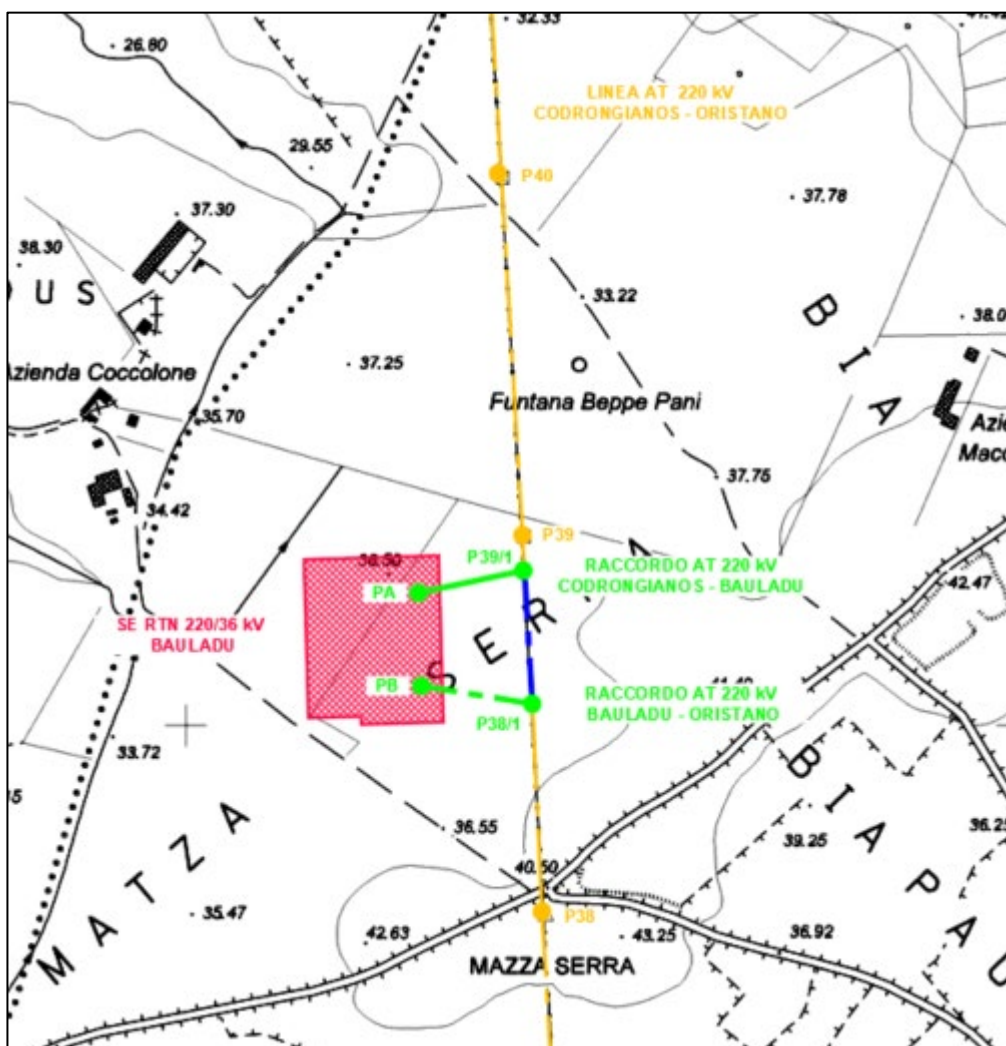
stralcio della planimetria con indicazione delle opere in progetto
